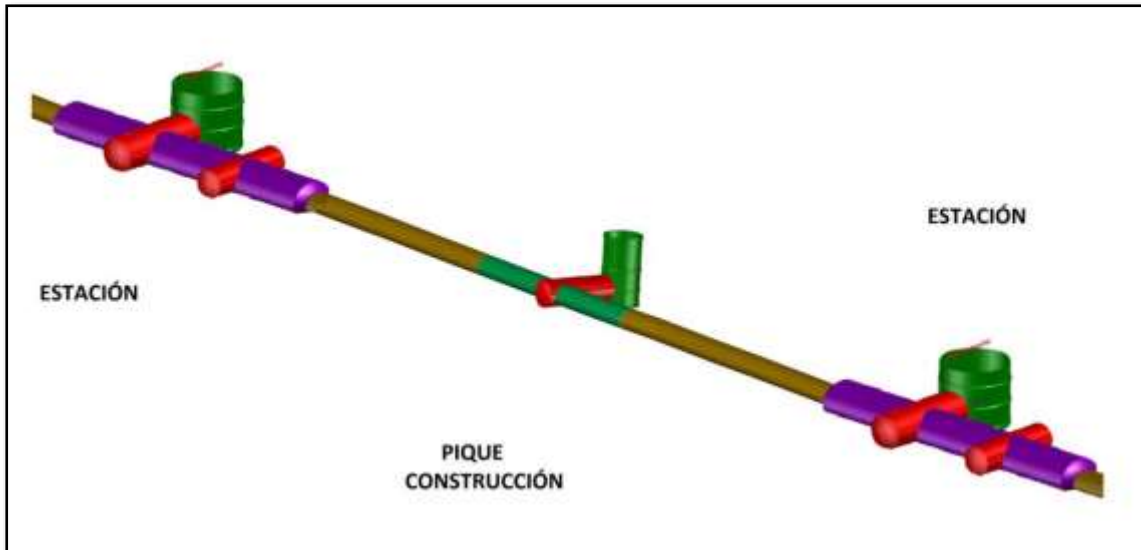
Pique de construcción y tramo de túnel interestación.[18]
